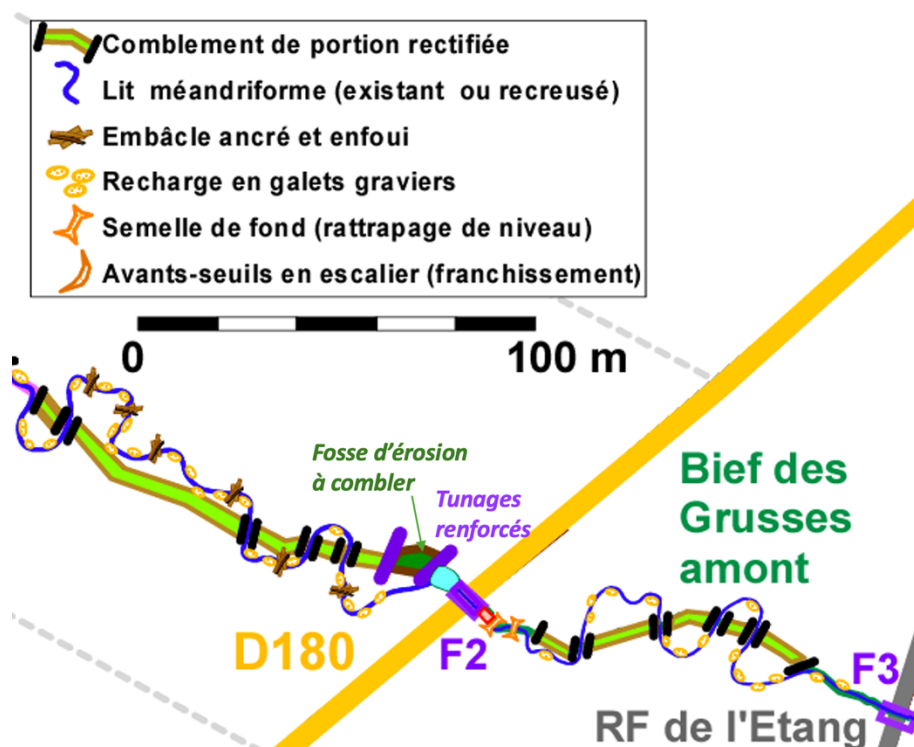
Plan du projet de restauration du Bief des Grusses dans le secteur de la D180
